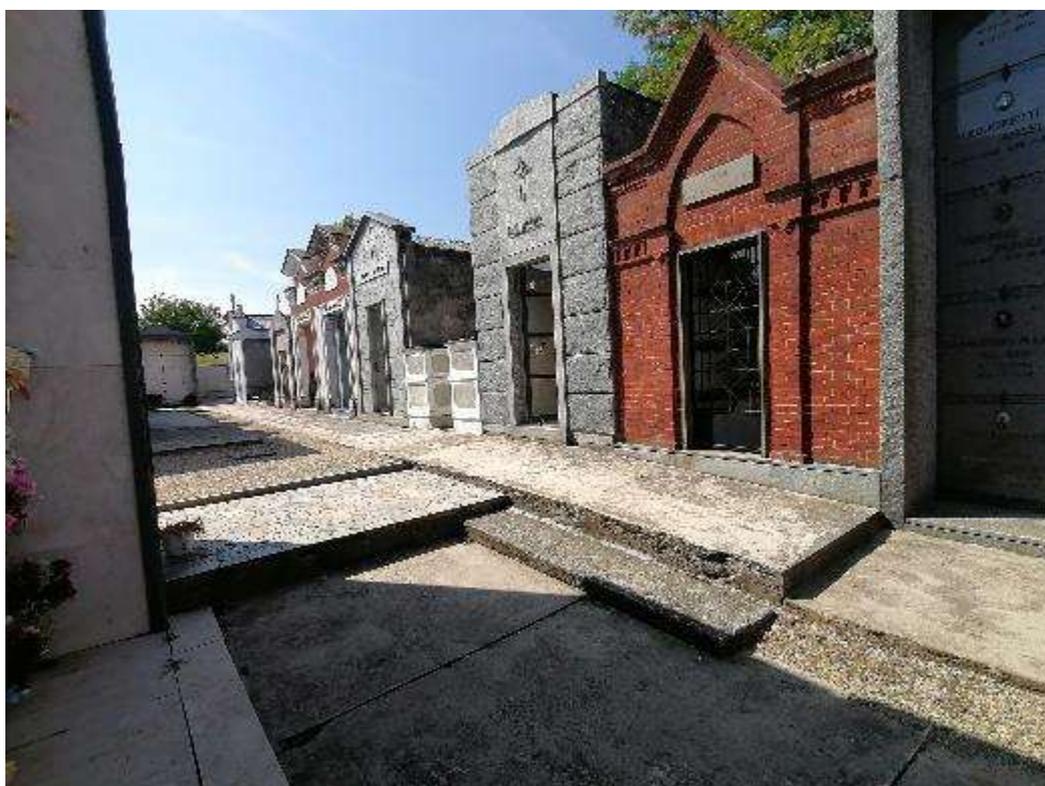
Situazione stato esistente delle pavimentazioni dove sarà realizzato l'intervento B di realizzazione della rampa disabili
